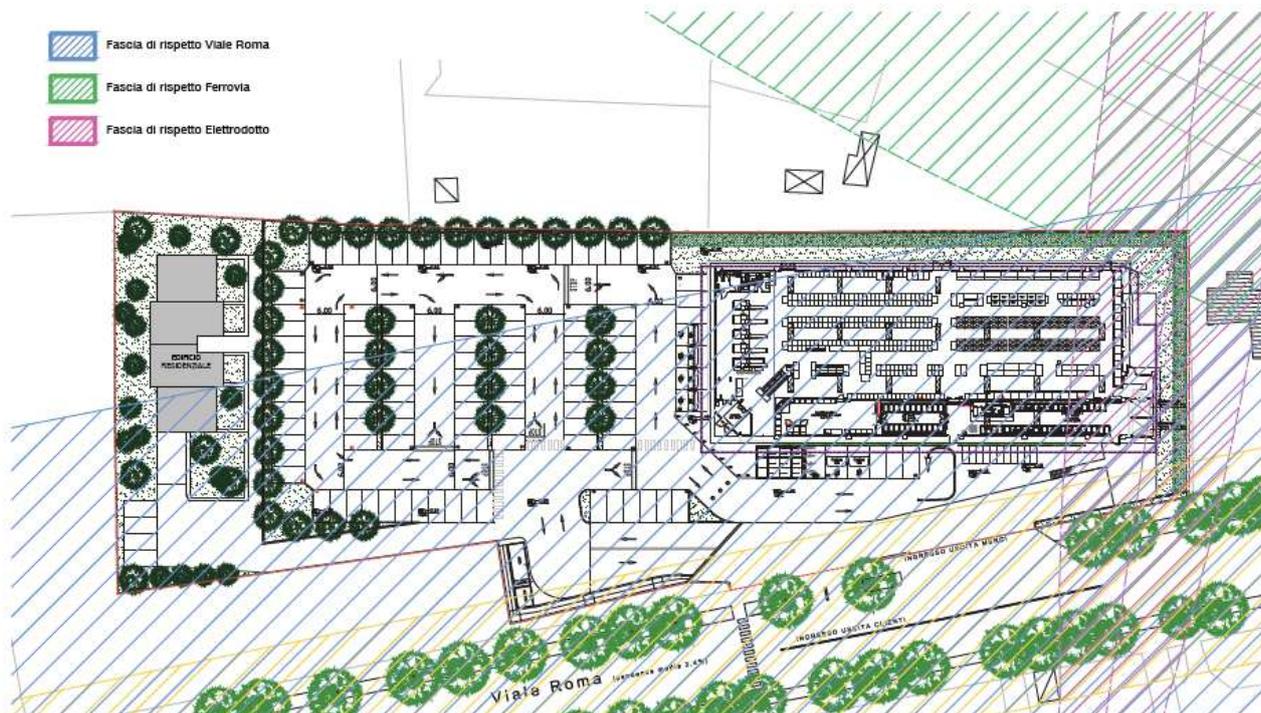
Planimetria del Piano attuativo con indicate le fasce di rispetto DPR 753-11 luglio 1980
